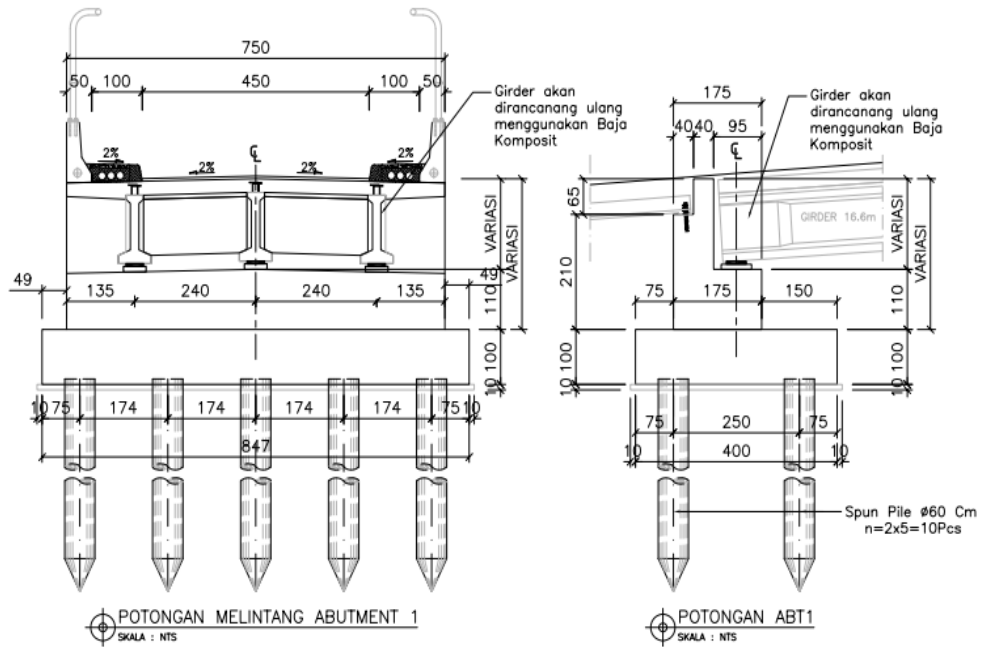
Girder* PCI 30 m Eksisting dan Desain ulang
